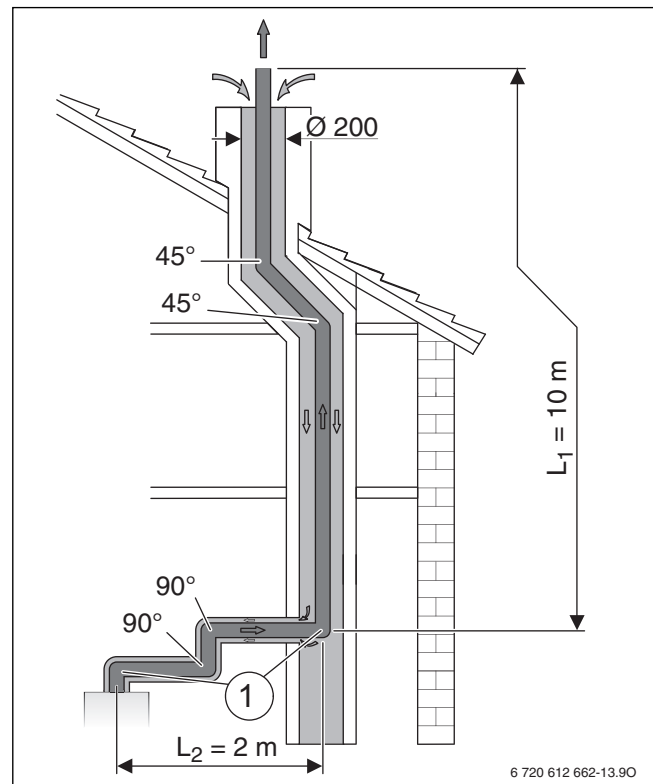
Einbausituation einer Abgasführung nach C_{93x}
